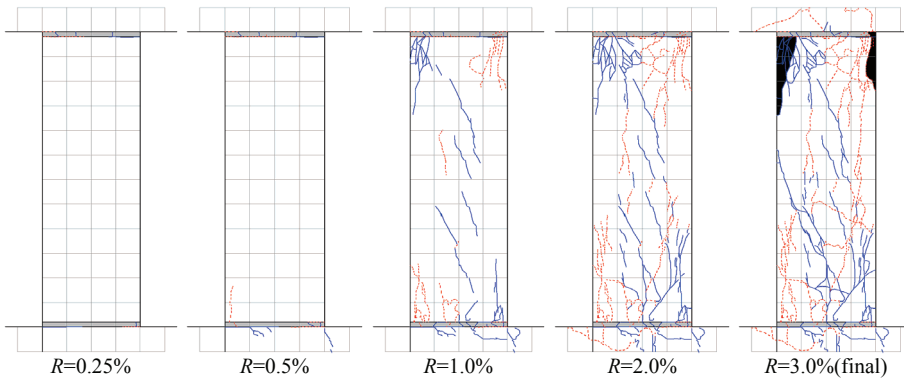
B1/2-0.2 ひび割れ状況
